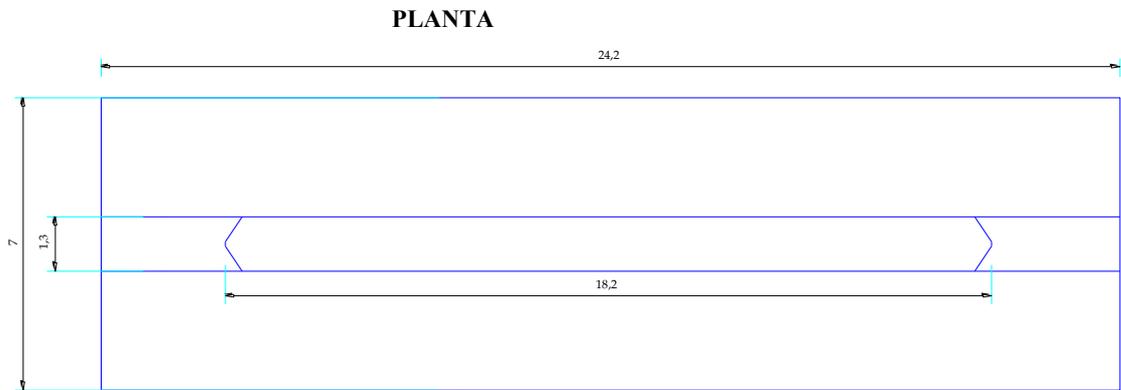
DETALLES DE PILA CENTRAL PROPUESTA EN LA RECONSTRUCCIÓN DEL PUENTE 17 DE SEPTIEMBRE.
